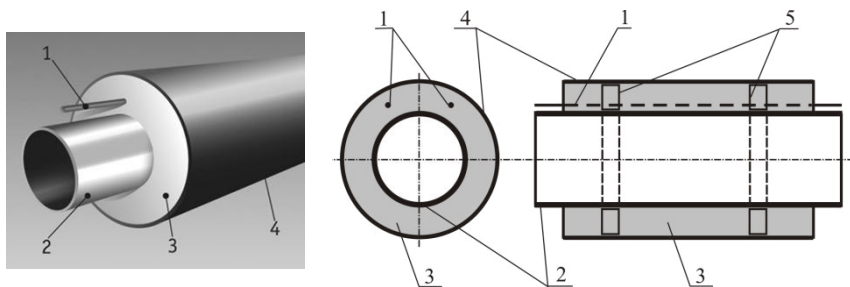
Конструкція попередньо ізольованого трубопроводу
